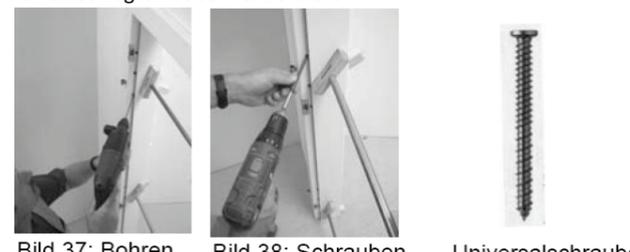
Bohren Bild 38: Schrauben Universalschraube
